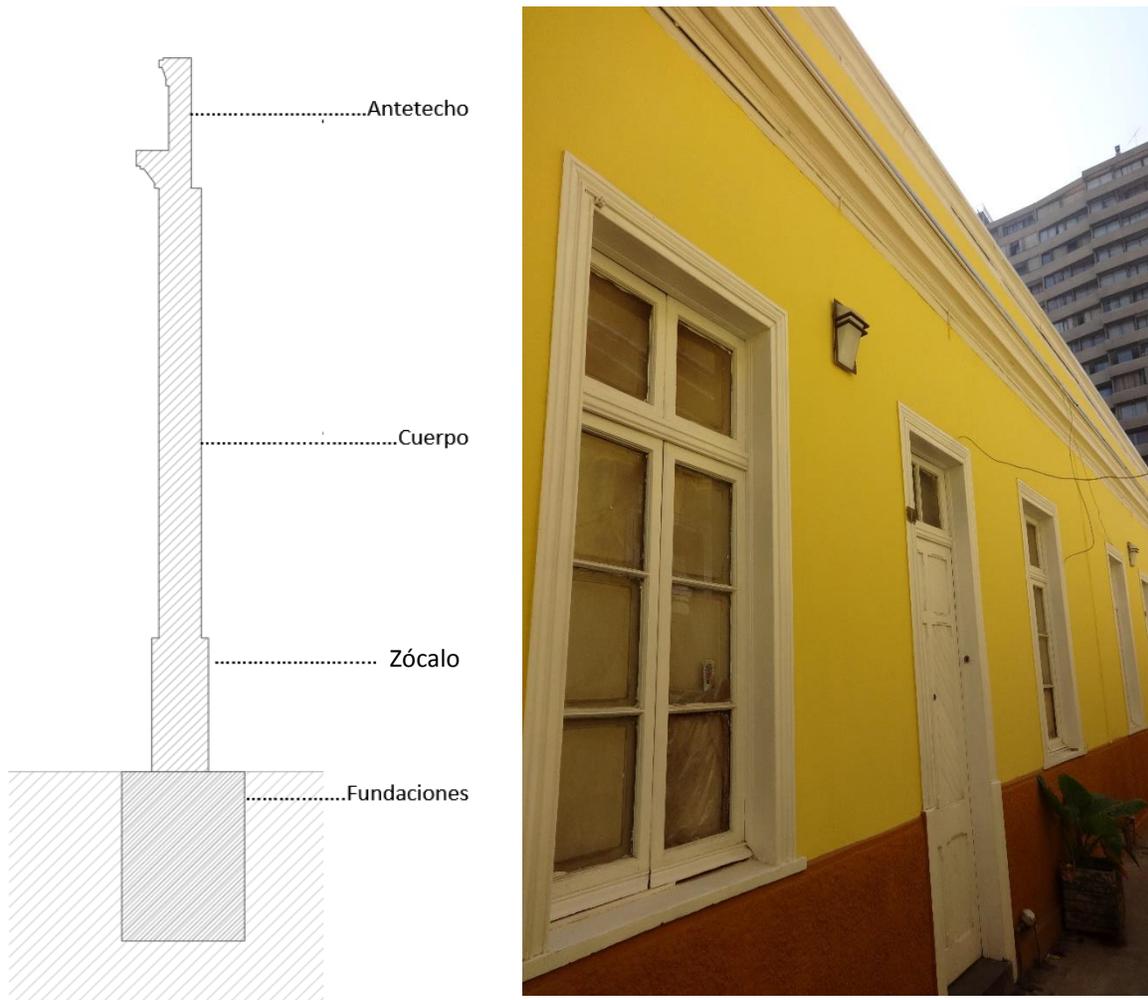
Esquema de corte muro, donde se ve la diferencia de espesor en muro. 160) Imagen del interior del conjunto.
